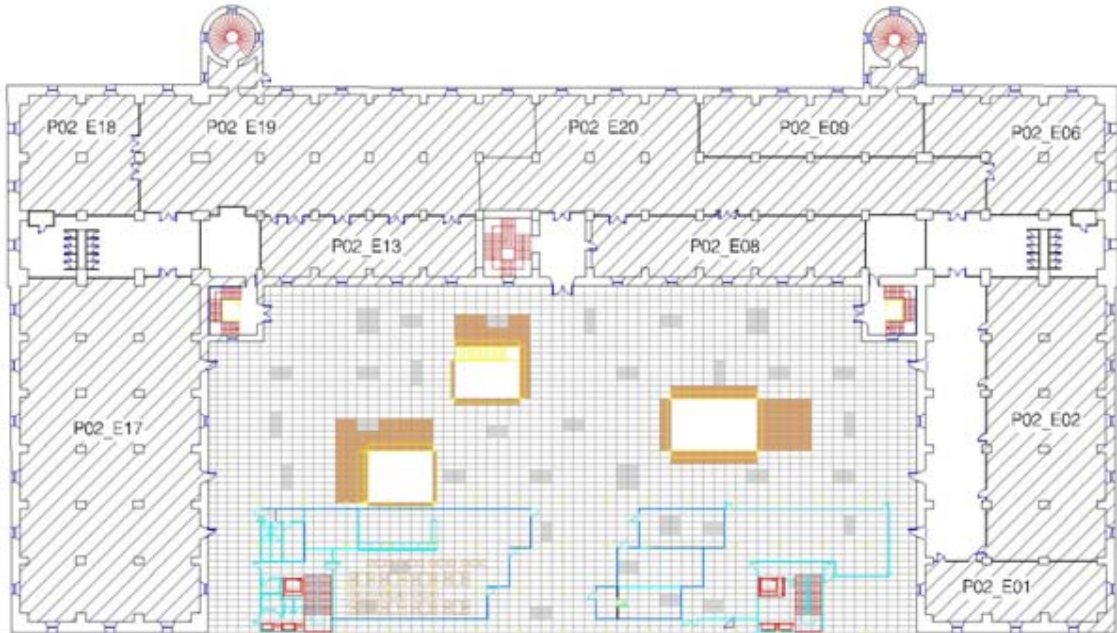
Agrupación de zonas planta baja edificio antiguo
